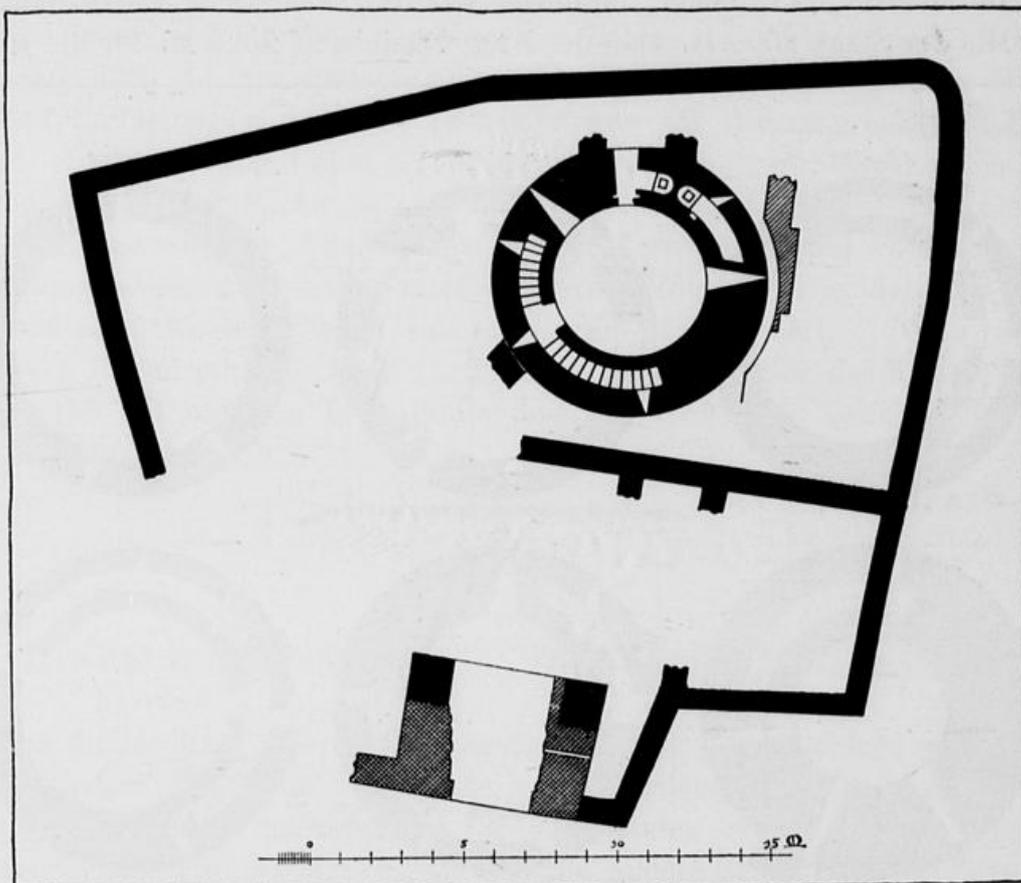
Burg Rheinbach. Grundriss der Hochburg.
